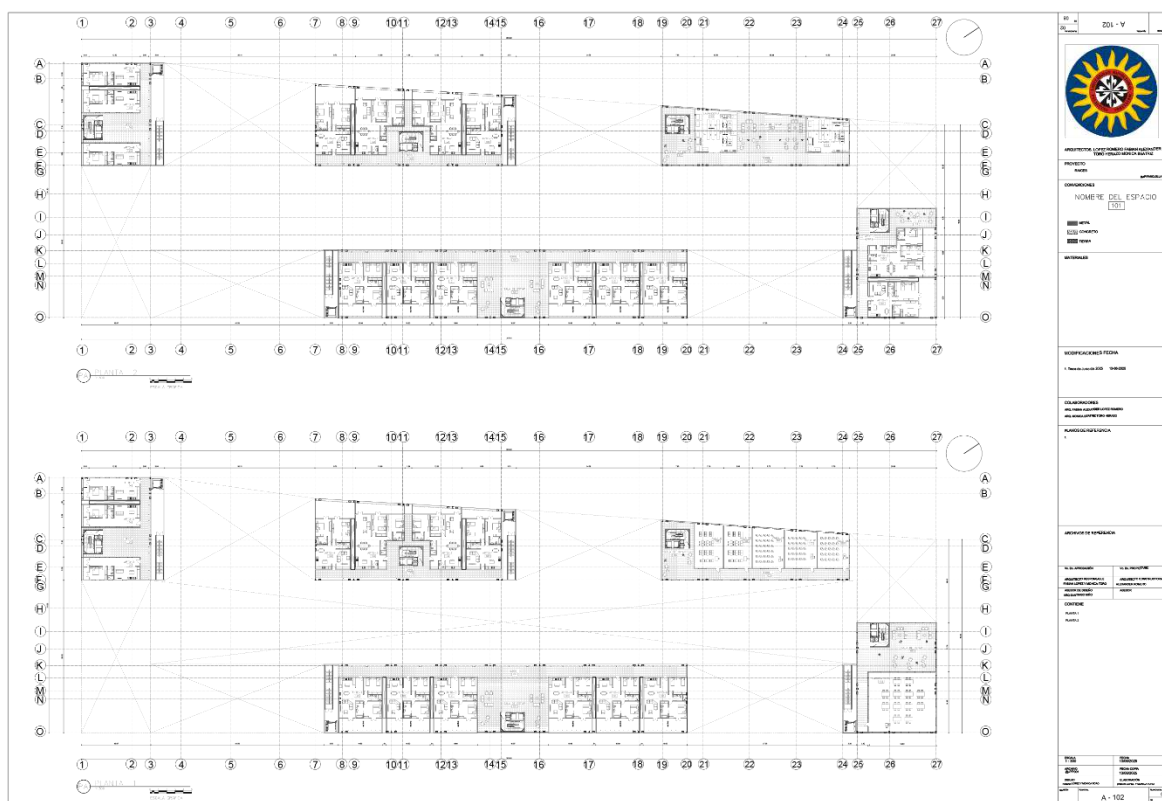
Planimetría Planta 1-2. Fuente: Elaboración propia.
